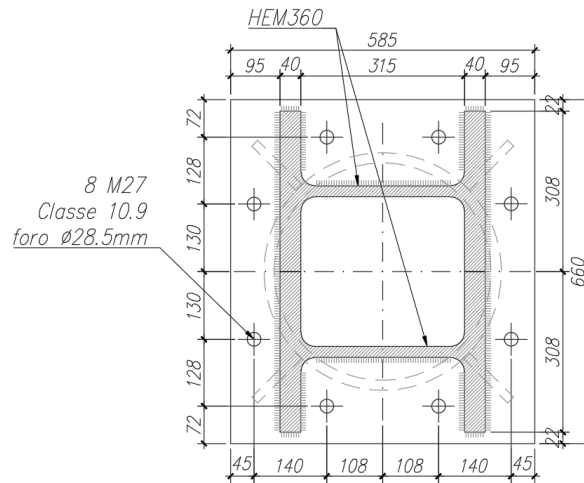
Elemento di collegamento tra puntone tubolare e trave di ripartizione (SLU – A1+M1+R1)
